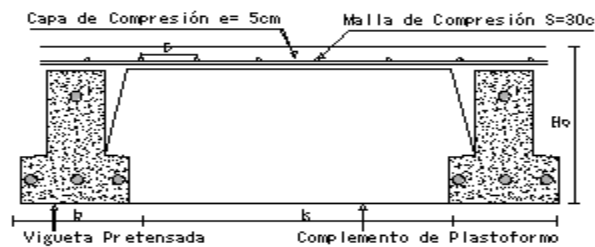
Partes constructivas de la losa, Elaboración Propia.
